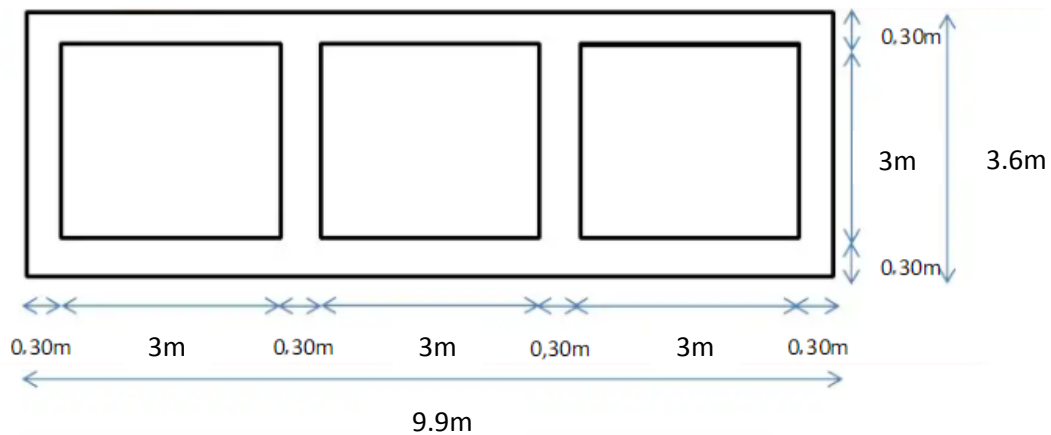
profile en travers du dalot de Belota tronçon G3
